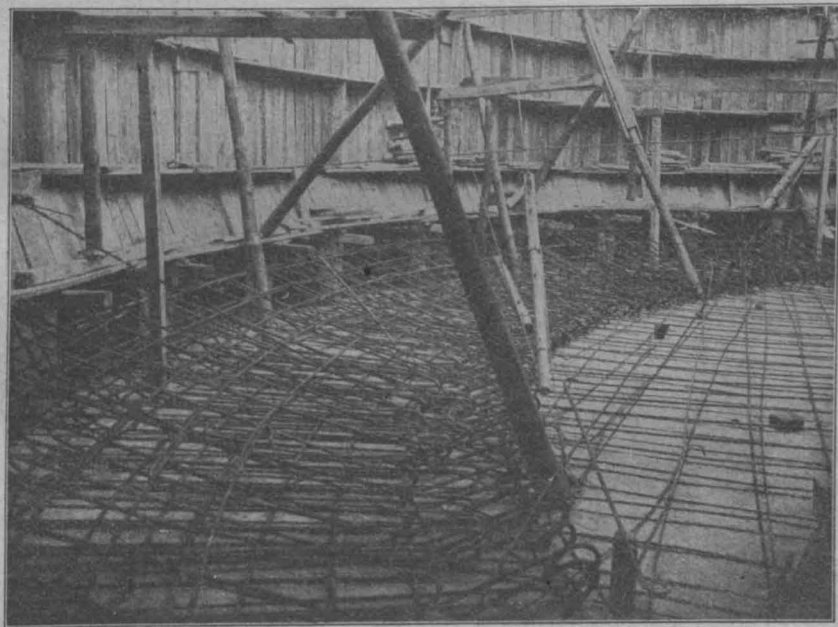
Eisenbewehrung der Sohle des Wasserbehälters. (Industriewerk i. O.-S.)
